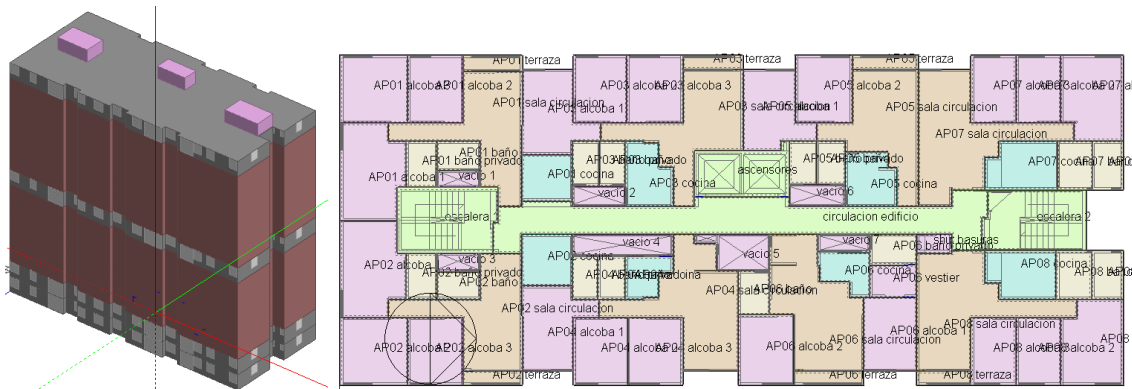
Volumetría 3D y planta de la tipología en Design Builder. Fuente: Elaboración propia, usando el software Design Builder
